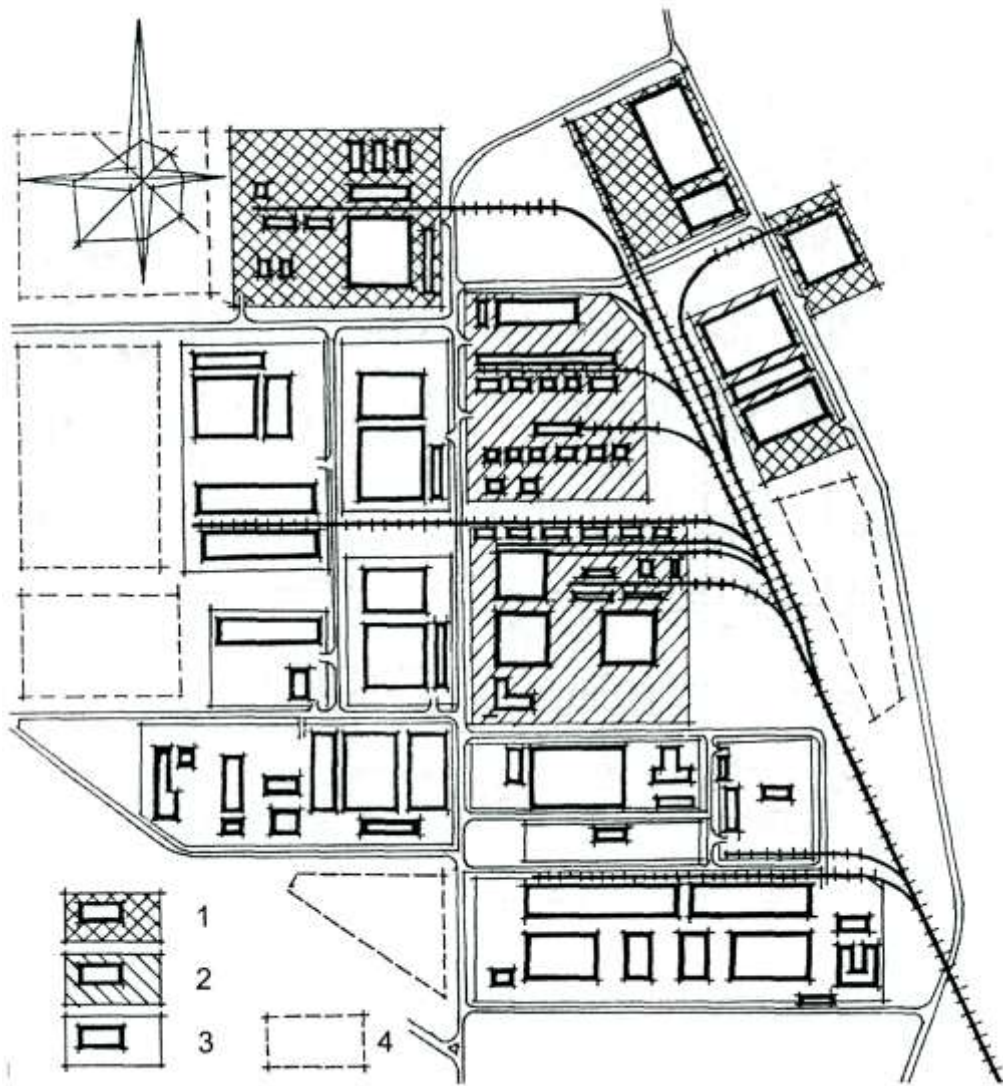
Промисловий вузол. Схема генерального плану:
